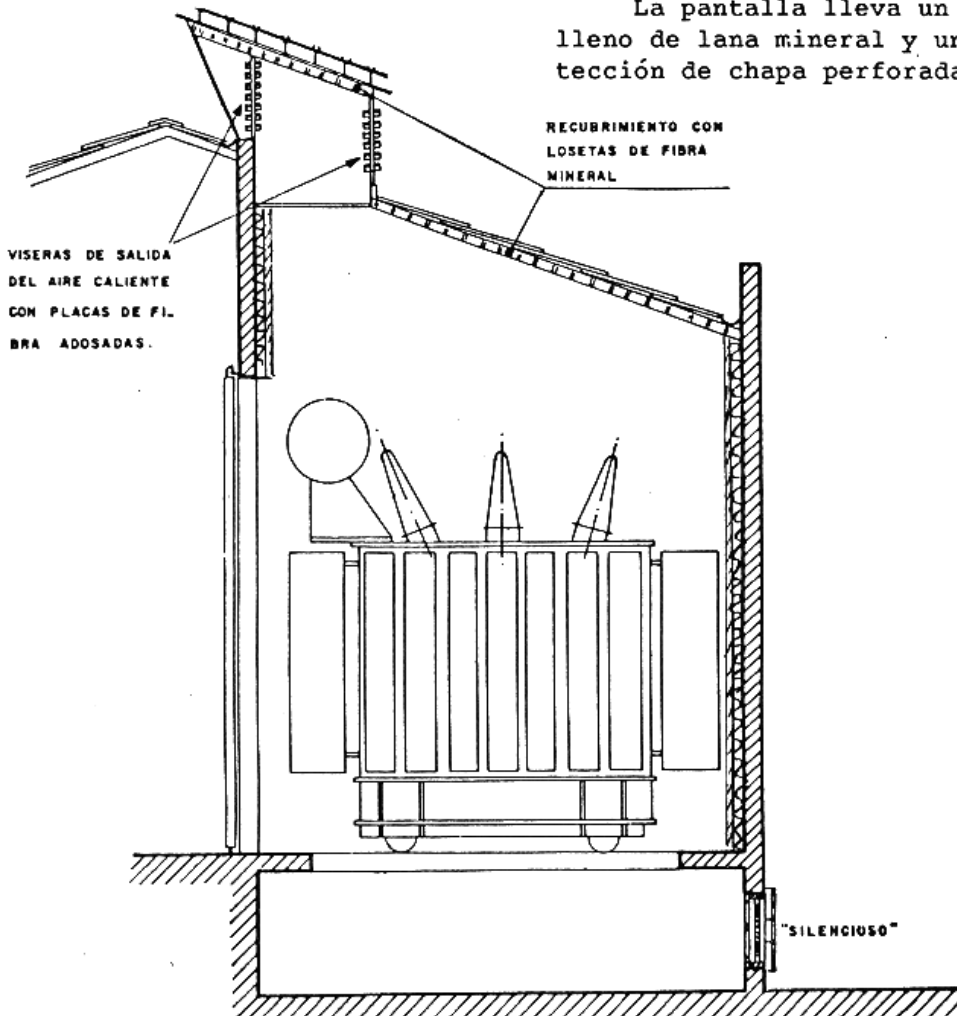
Recubrimiento con losetas de fibra mineral bajo la cubierta de las celdas de transformadores.
